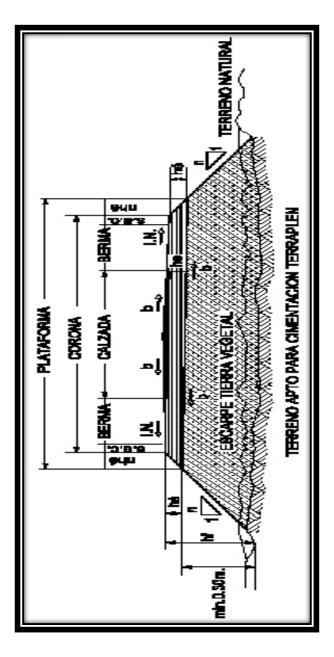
Sección tipo estructural en TERRAPLEN
